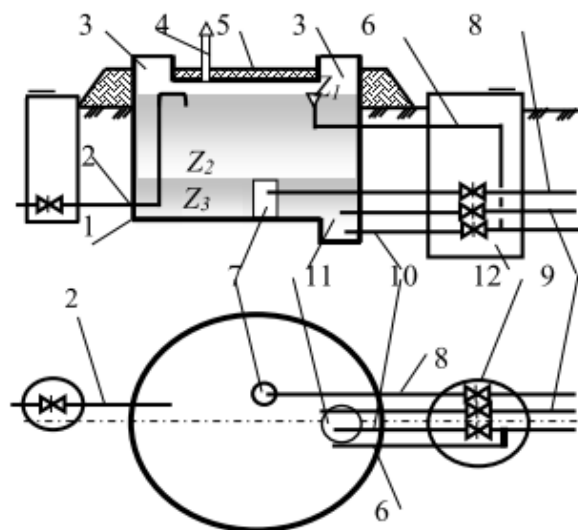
Резервуар для зберігання чистої води: 1 – корпус резервуара; 2 – подавальний трубопровід; 3 – оглядові колодязі; 4 – вентиляційна труба; 5 – обвалування; 6 – переливна труба; 7 – колодязь для забезпечення непорушності пожежного запасу; 8 – трубопровід для відбору води для господарських потреб; 9 – трубо-провід для відбору води на пожежні потреби; 10 – труба відведення бруду; 11 – прямик; 12 – камера переключень
